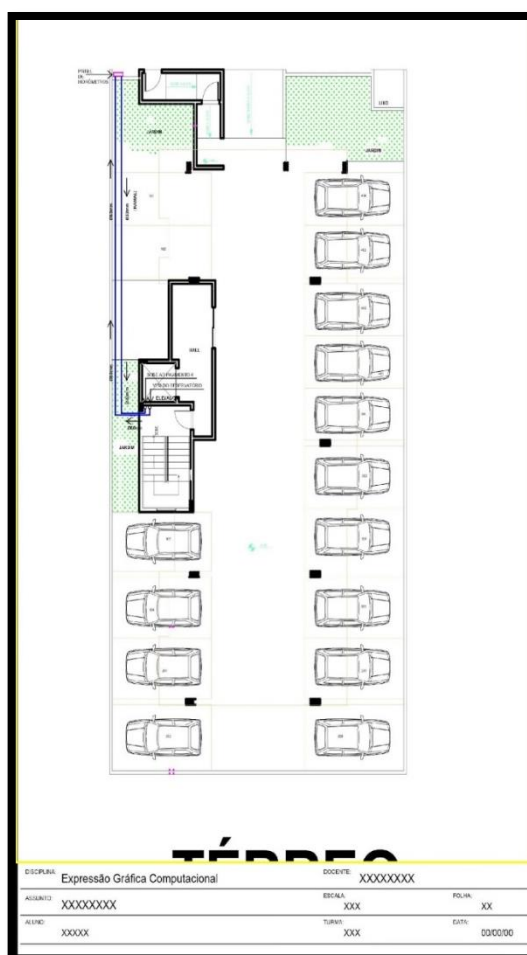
Painel de hidrômetros posicionado no muro da edificação.
